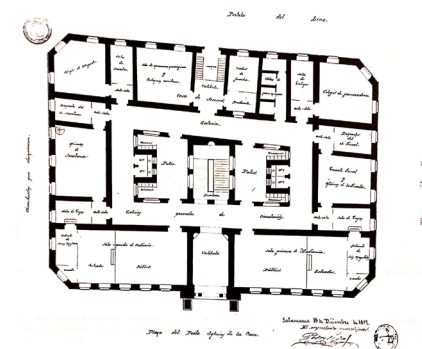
Plano planta baja Palacio Justicia. Pedro Vidal. 1897
